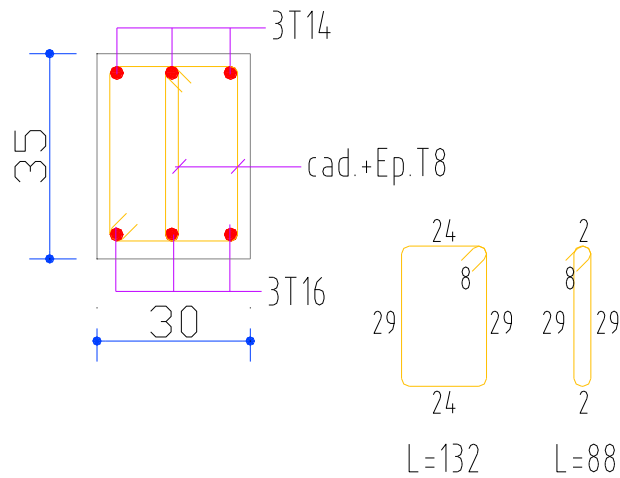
Ferrailage des poutres secondaires au niveau de travée de 1^{er} à 3^{ème} et de 8^{ème} à 13^{ème} étage.
